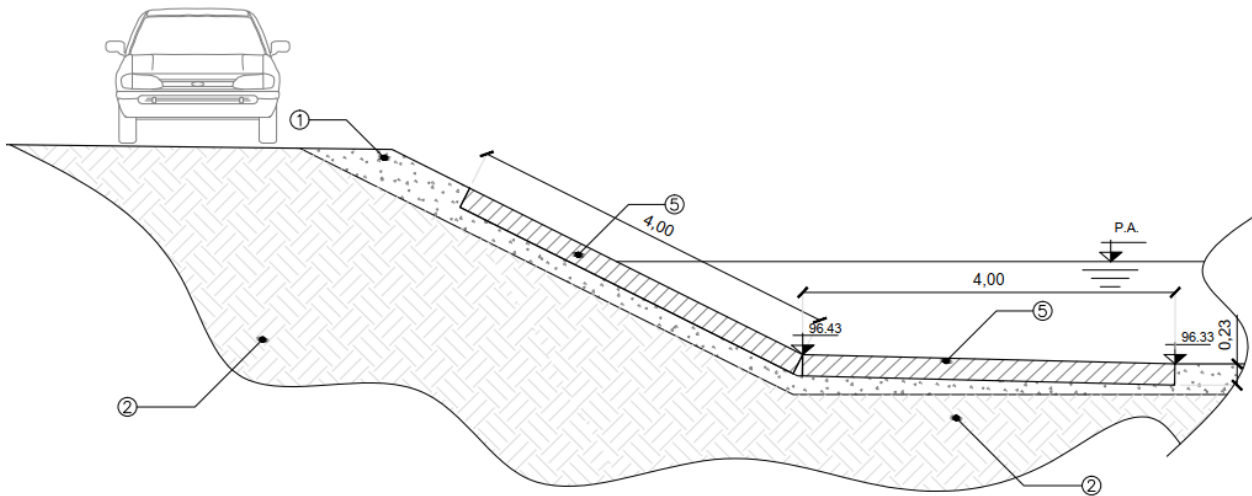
Perfil transversal O-O, obra de colchonetas existente correspondiente a la primera etapa.
